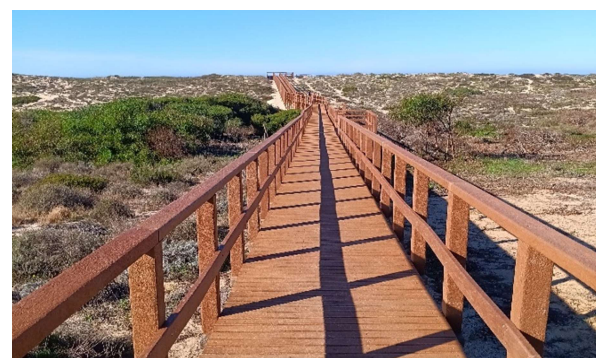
e 17 – Fotografias finais da obra de alteamento do passadiço
